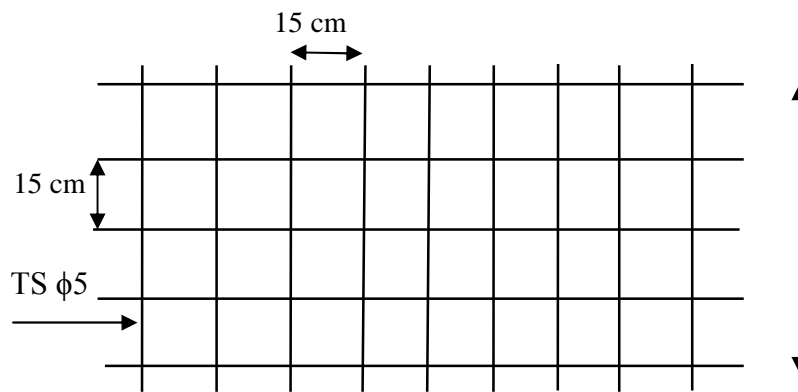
Schéma de ferrailage de la dalle à Corps creux
